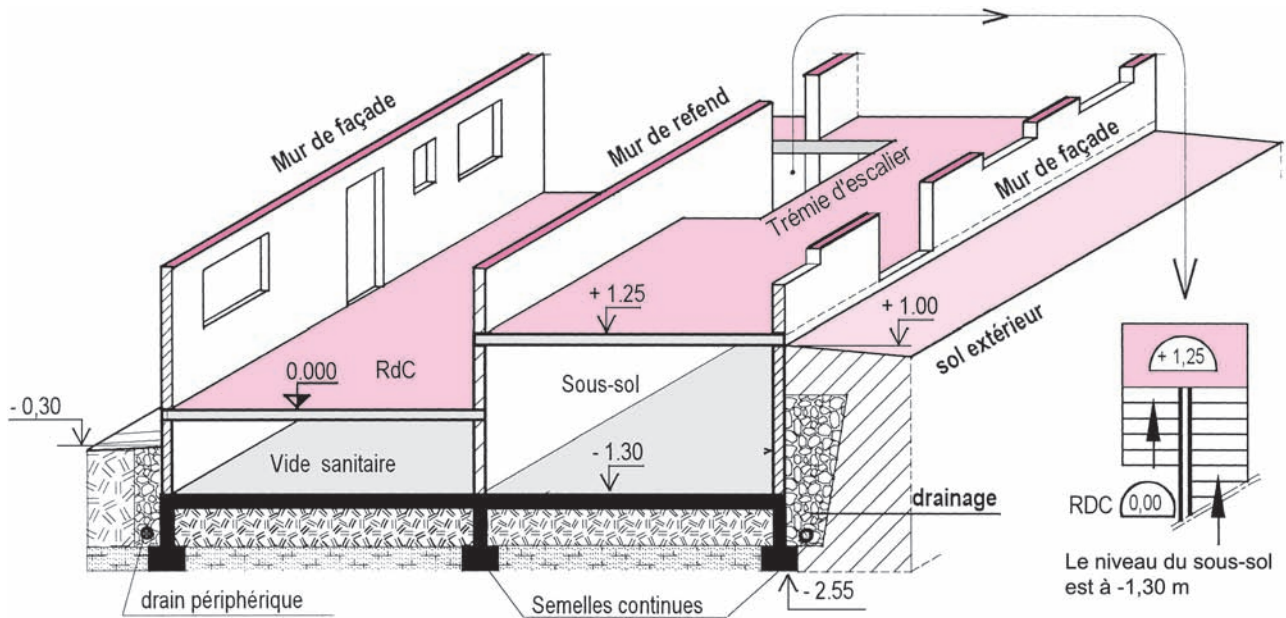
Maison à niveaux décalés sur vide sanitaire et sous-sol
